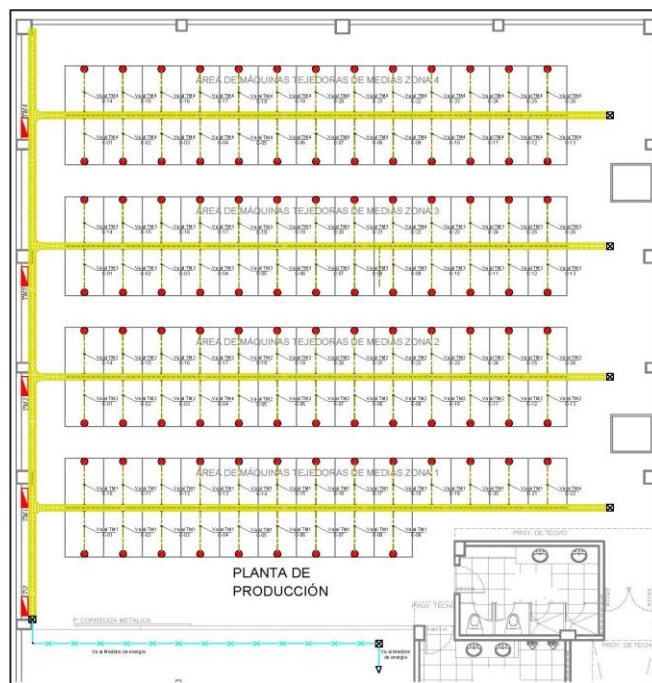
Plano de distribución de las máquinas tejedoras en la Planta. Enlace de descarga.
